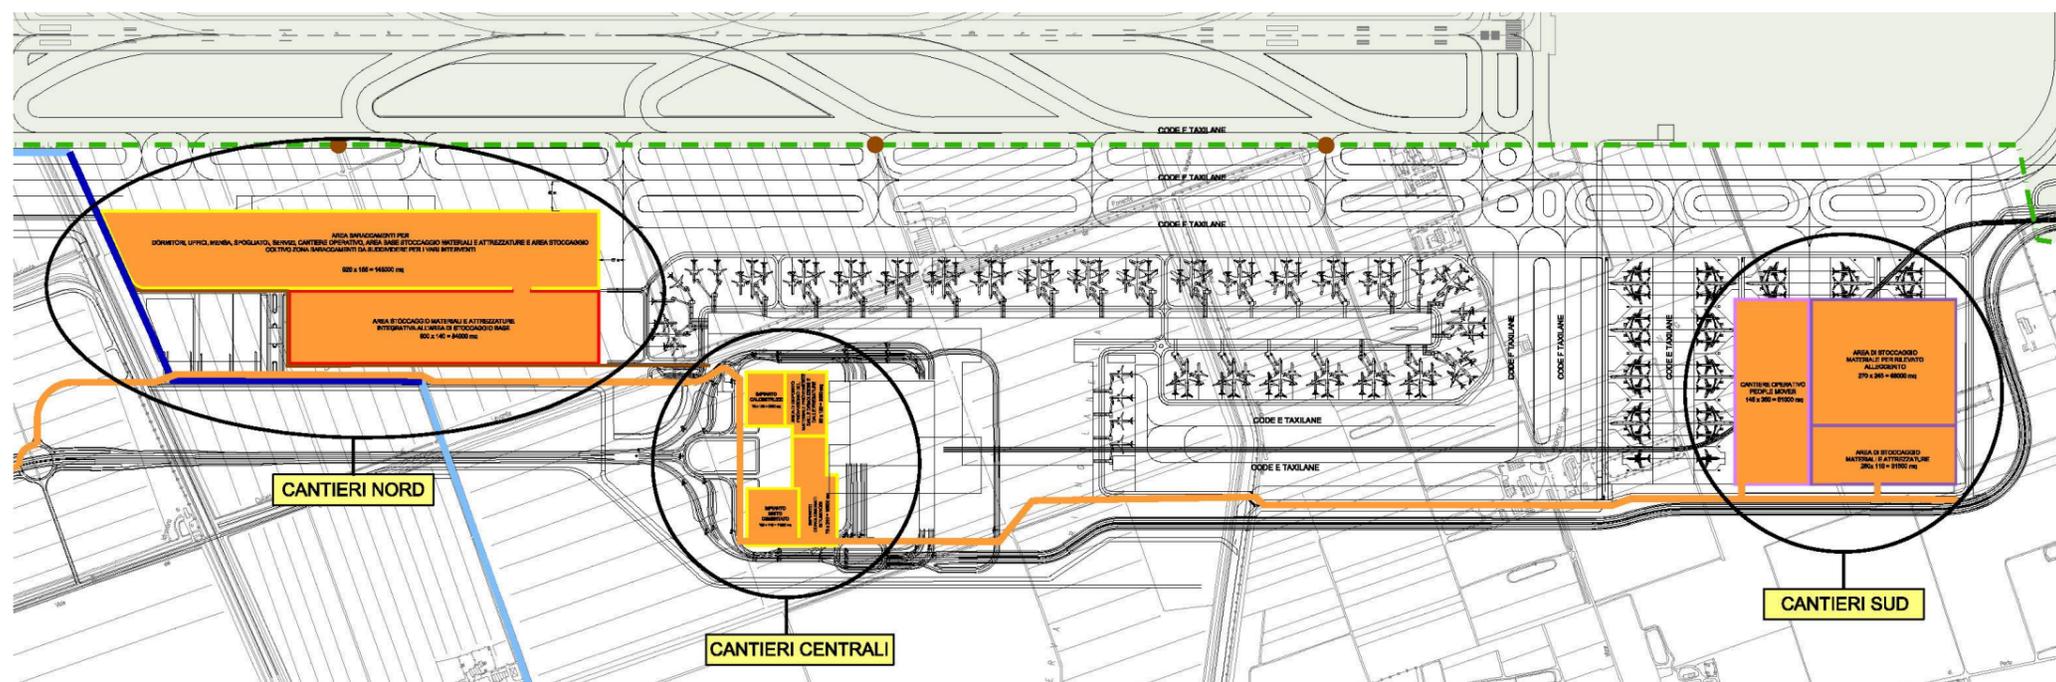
Planimetria con le aree di cantiere di Fase 2 - Layout
